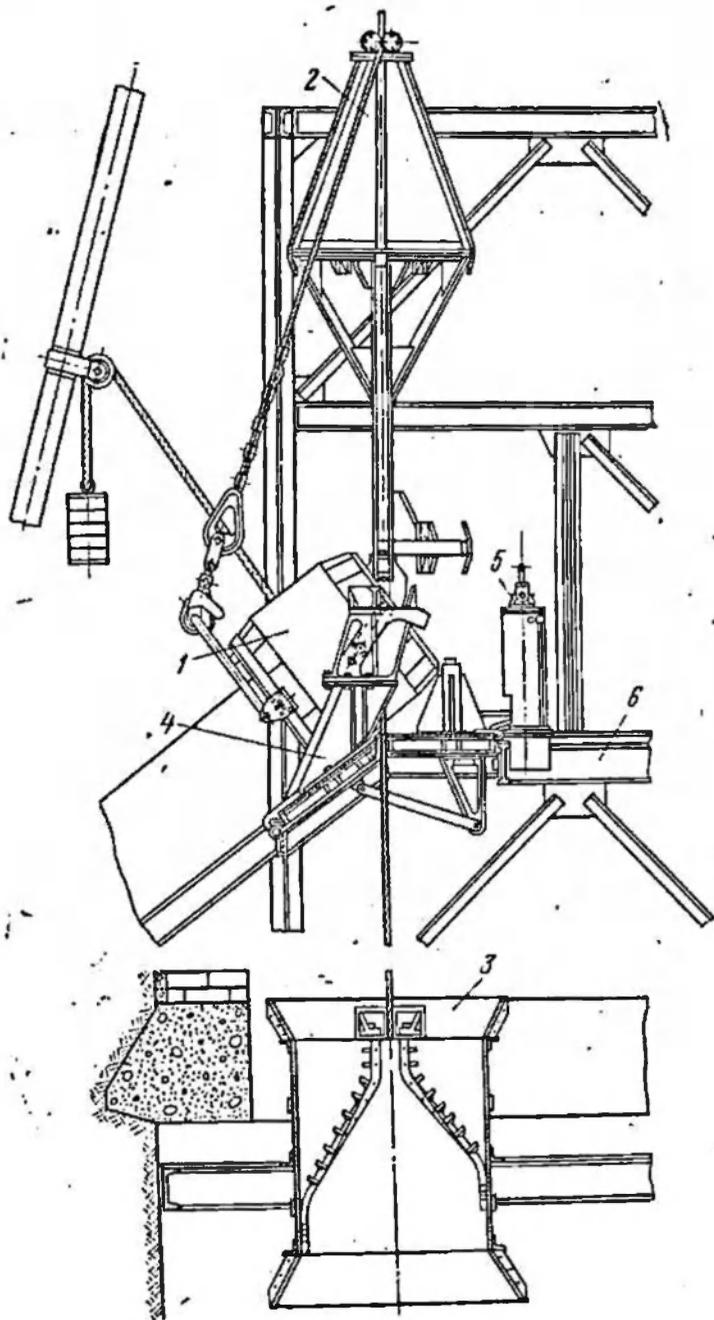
Устройство для разгрузки самопрокидывающейся бады типа БПС
